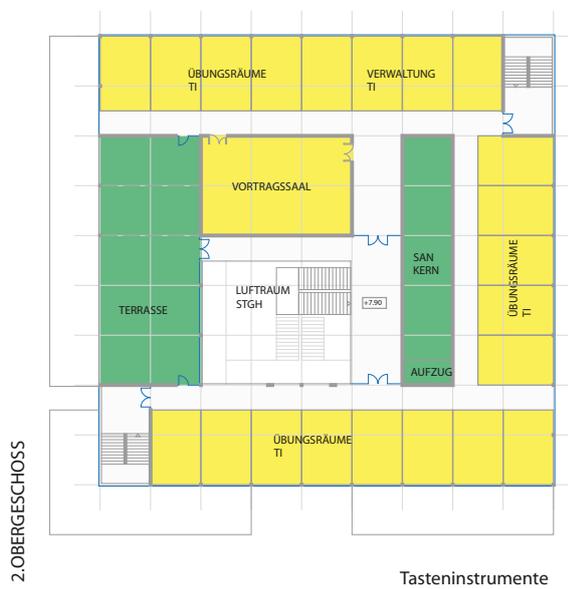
Vorentwurf _ Grundriss 2.OG
